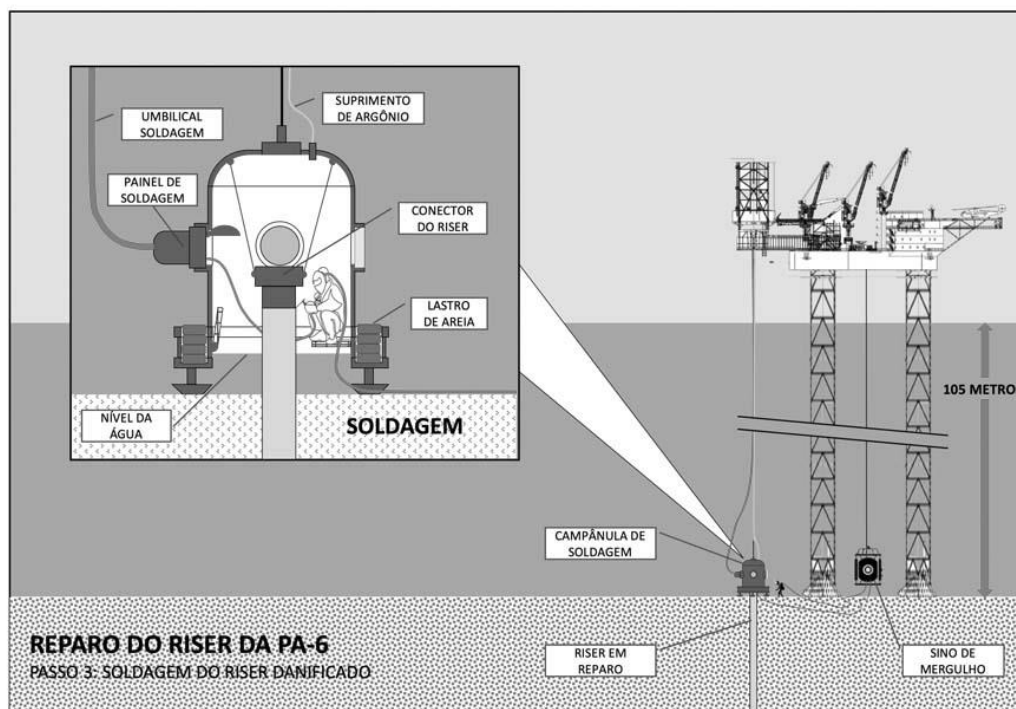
Sistema de soldagem no reparo da PA6.
